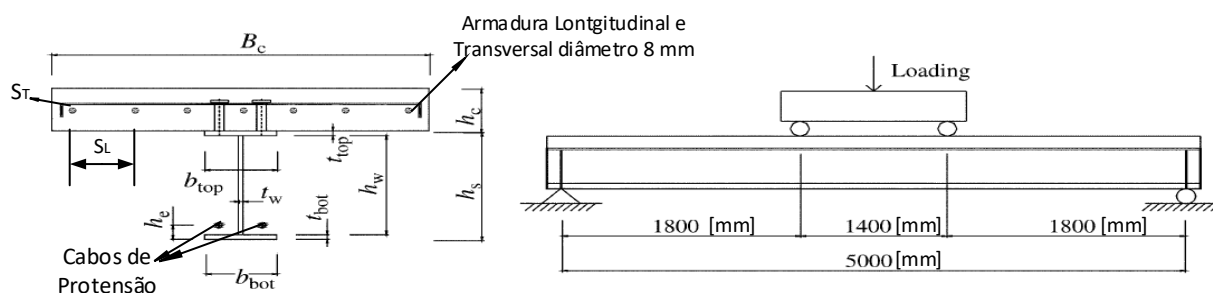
Geometria das vigas mistas BS1 e BS2 (CHEN e GU, 2005)
